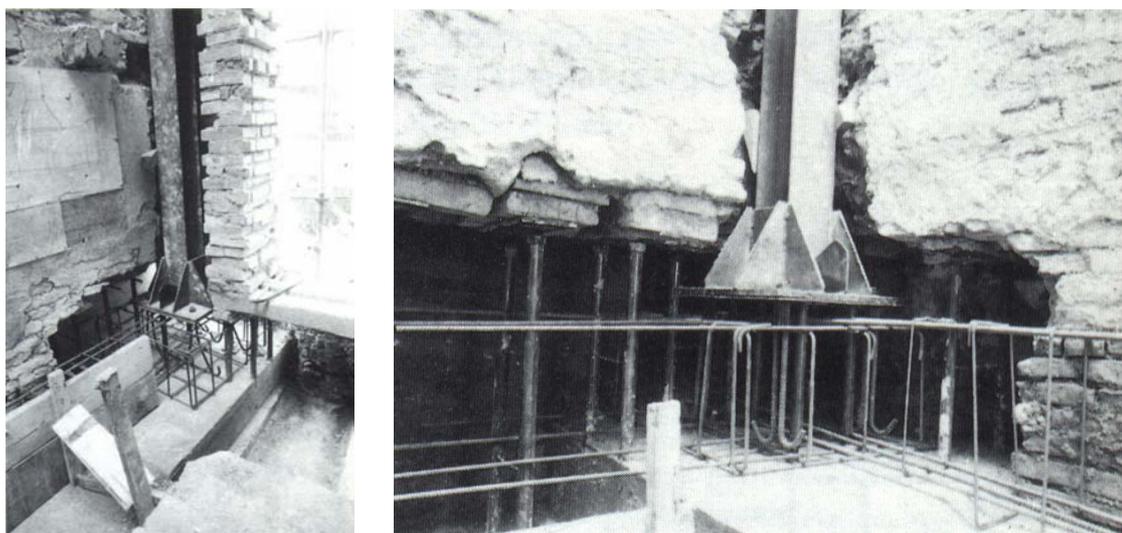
Inserção dos montantes em aço e nas fundações da estrutura de pedra existente.
